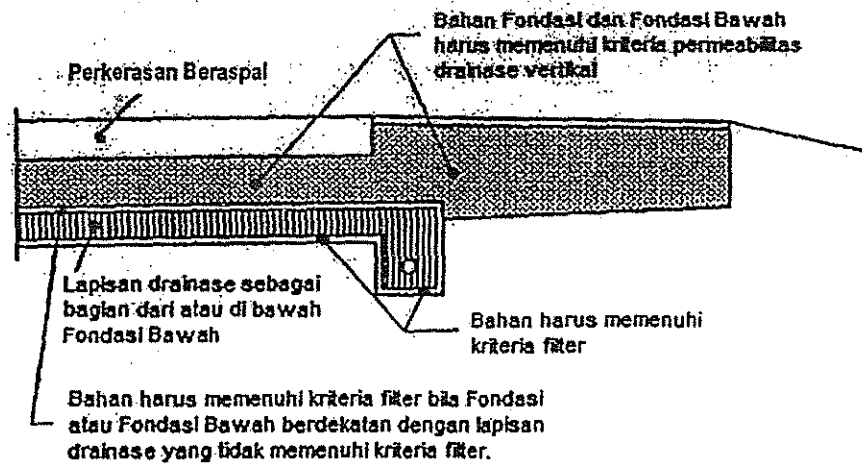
Drainase lapis fondasi (*base drainage*)
